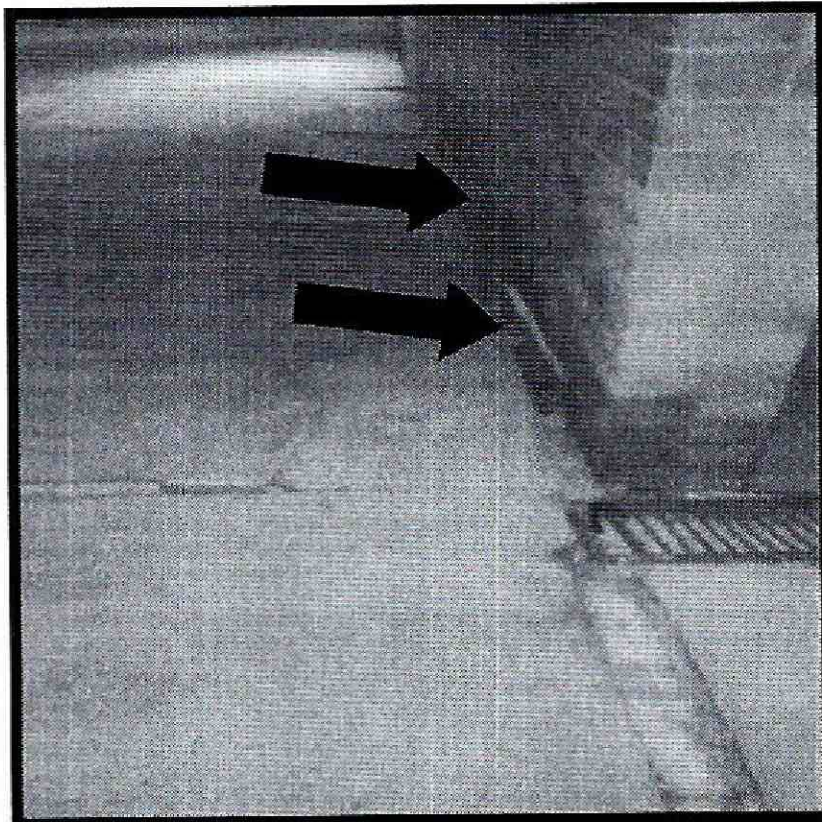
Fisuras sobre la placa de cimentación de tendencia longitudinal en el sótano e inclinación de la misma, cercana a los parqueaderos del costado Sur.
